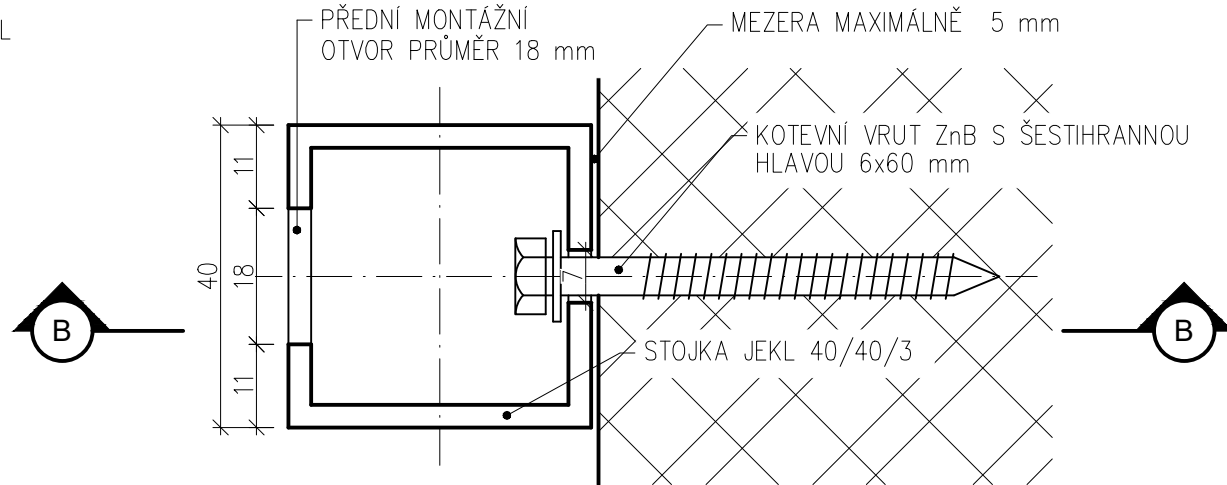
PATKY STOJKY - PŮDORYS 1:1
